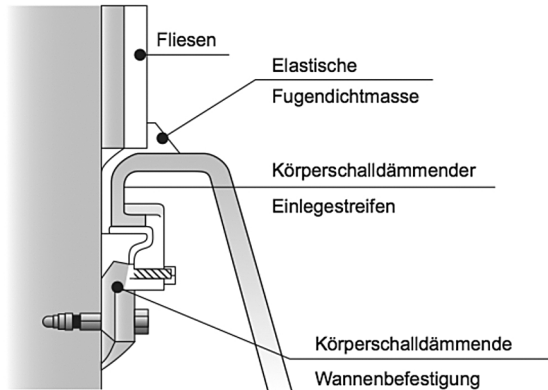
Montagedetail körperschalldämmte Anschlussfuge. (Quelle: Henrich)
